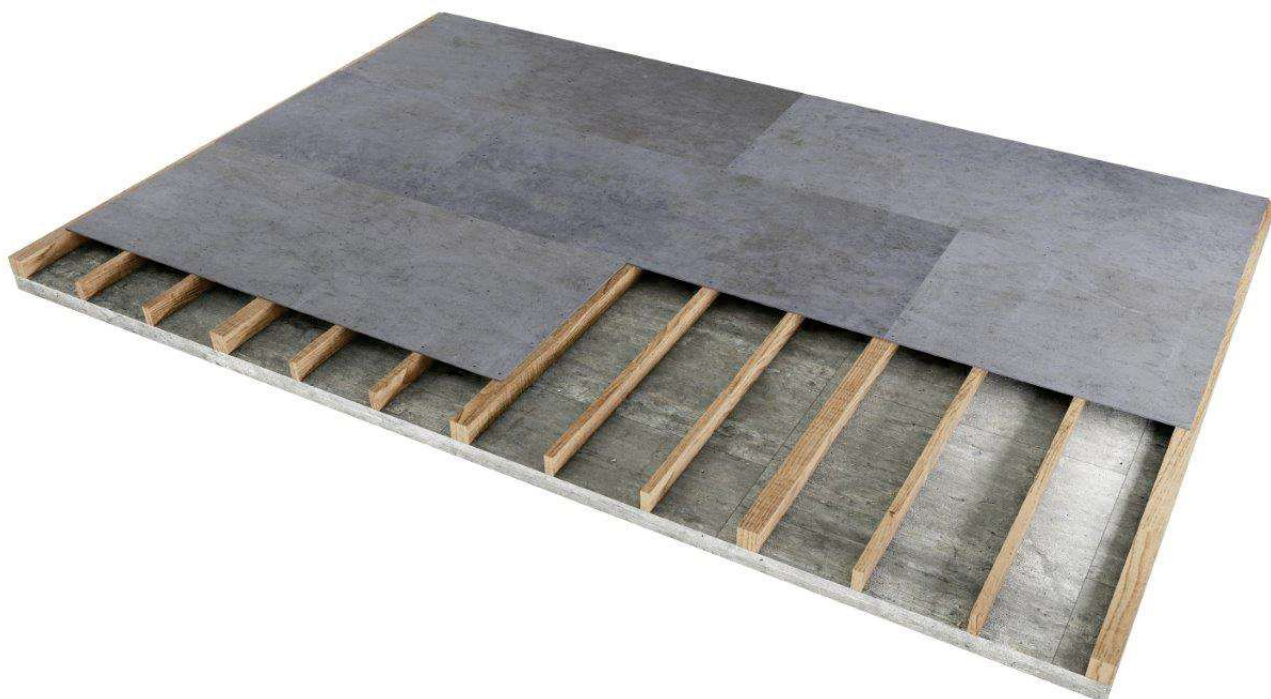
Pavimento Viroc apoiado sobre vigas
